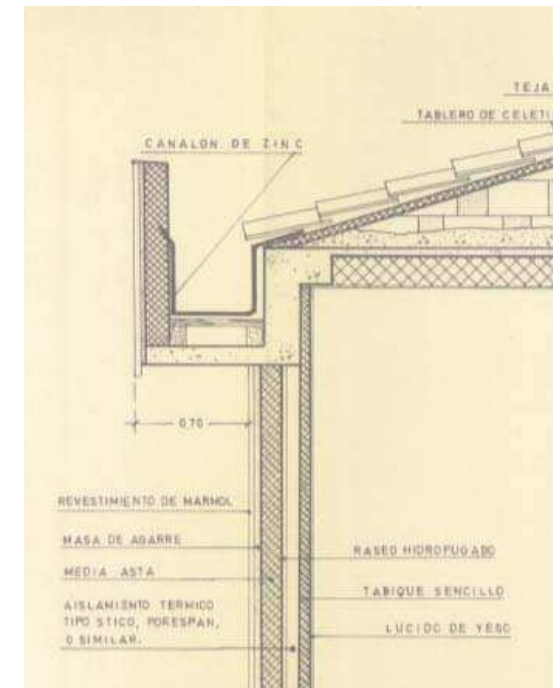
Detalle constructivo de fachada de edificio de 1974.
